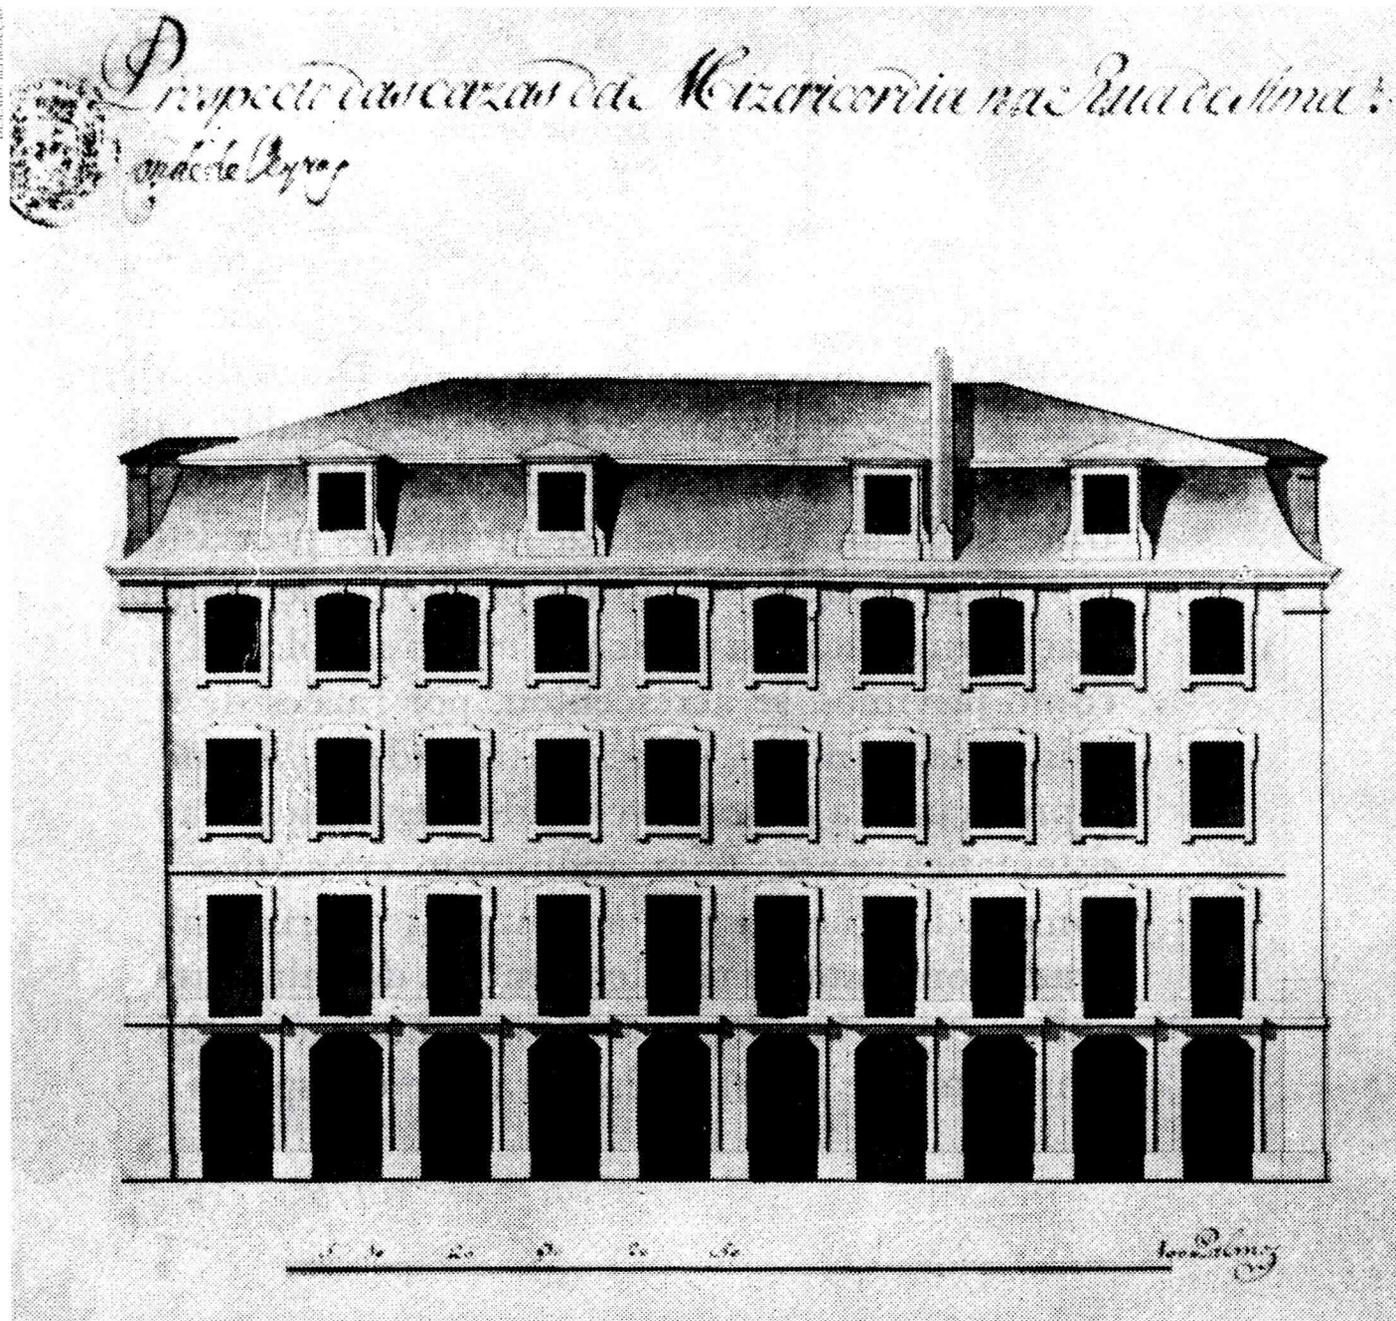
Fachada de tipo A com telhado “mardeliano”.
